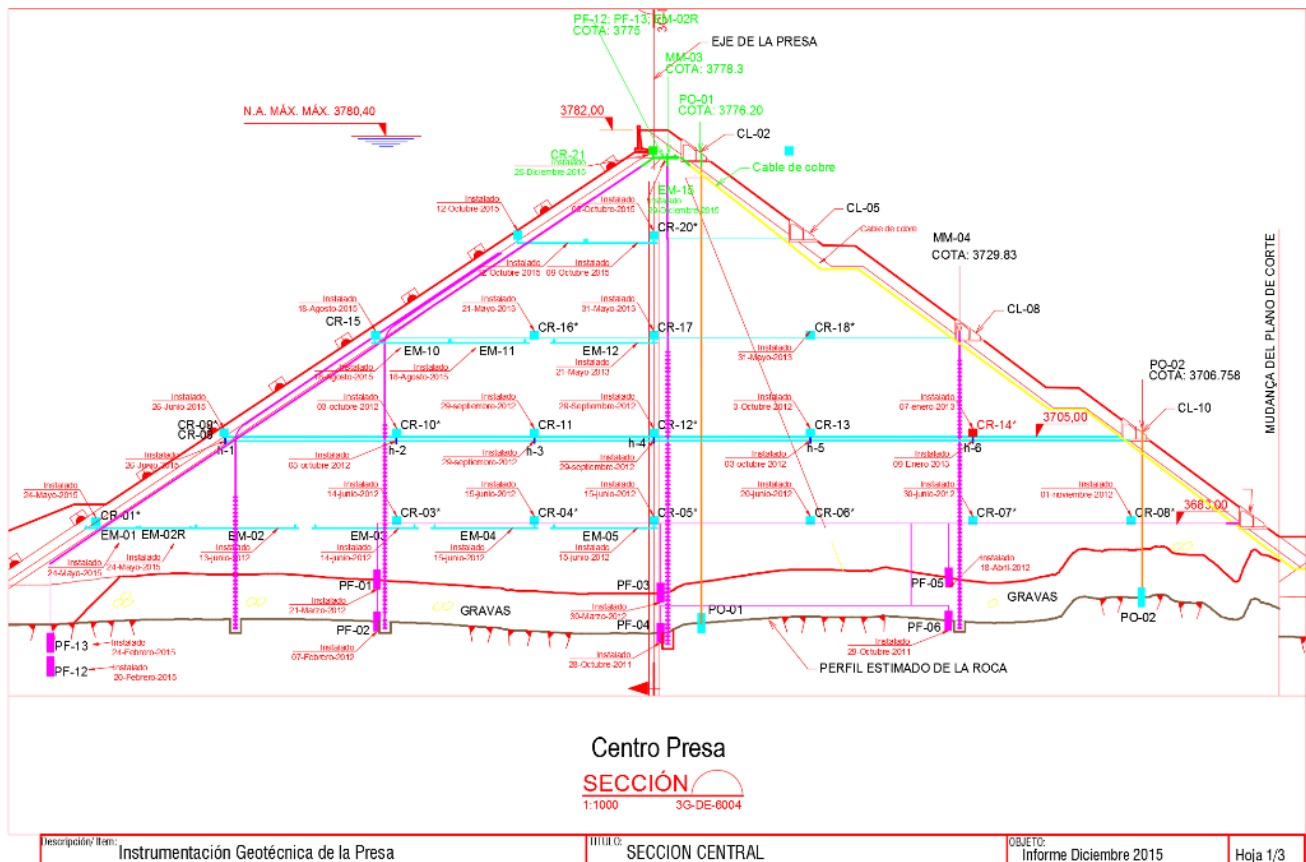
Sección central de la presa con el detalle de los instrumentos instalados.
